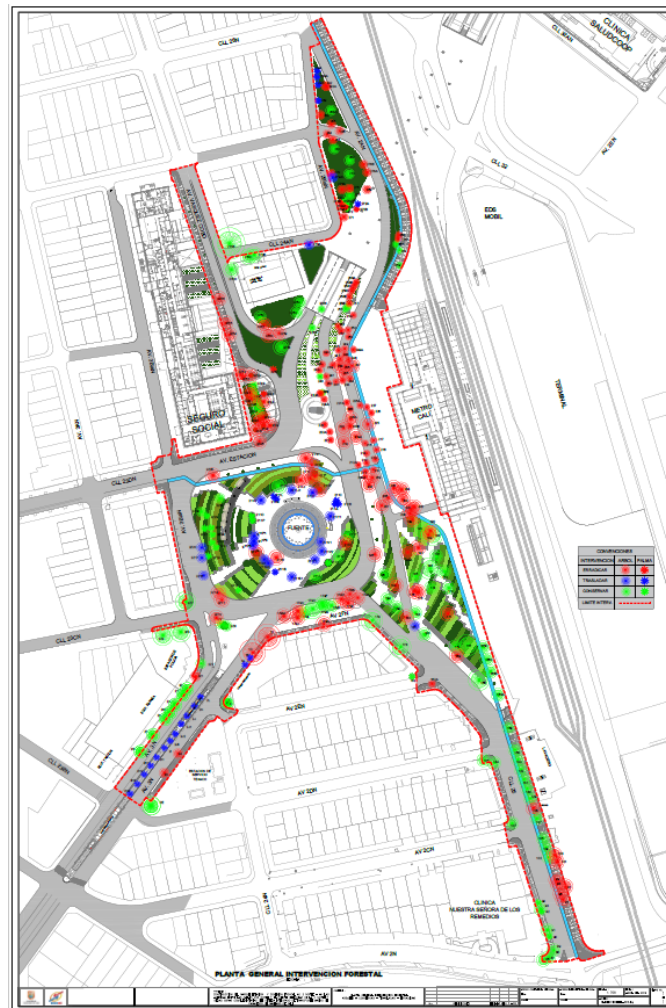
PLANTA GENERAL INTERVENCIÓN FORESTAL plano 1de 1
